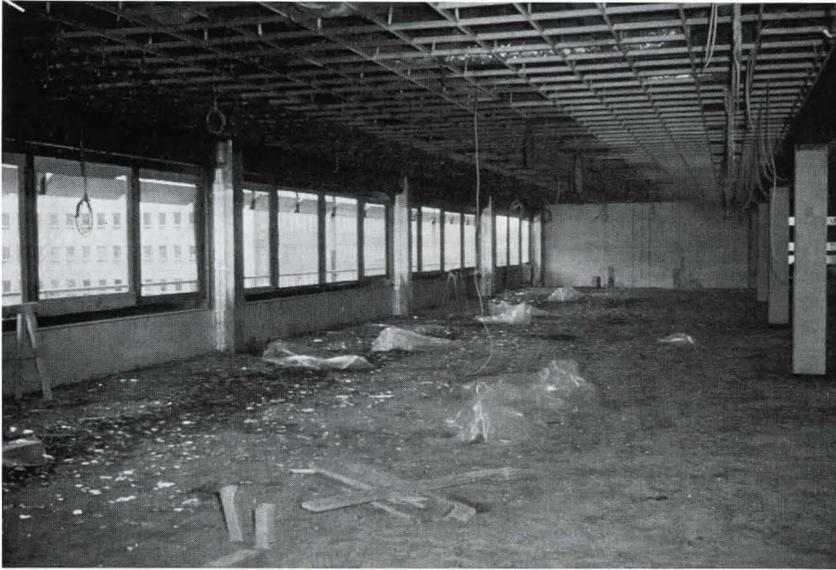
Der wärmedämmende Polyurethanschaum geriet durch Schweißarbeiten in Brand. (Foto: Gerhard Riwalzky.)
